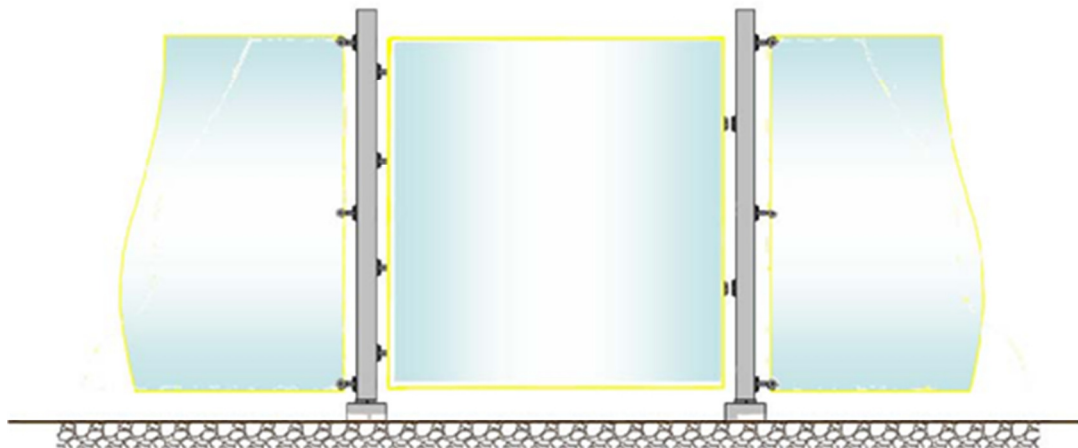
Delimitação do perímetro da Zona Controlada por painéis de vidro temperado
